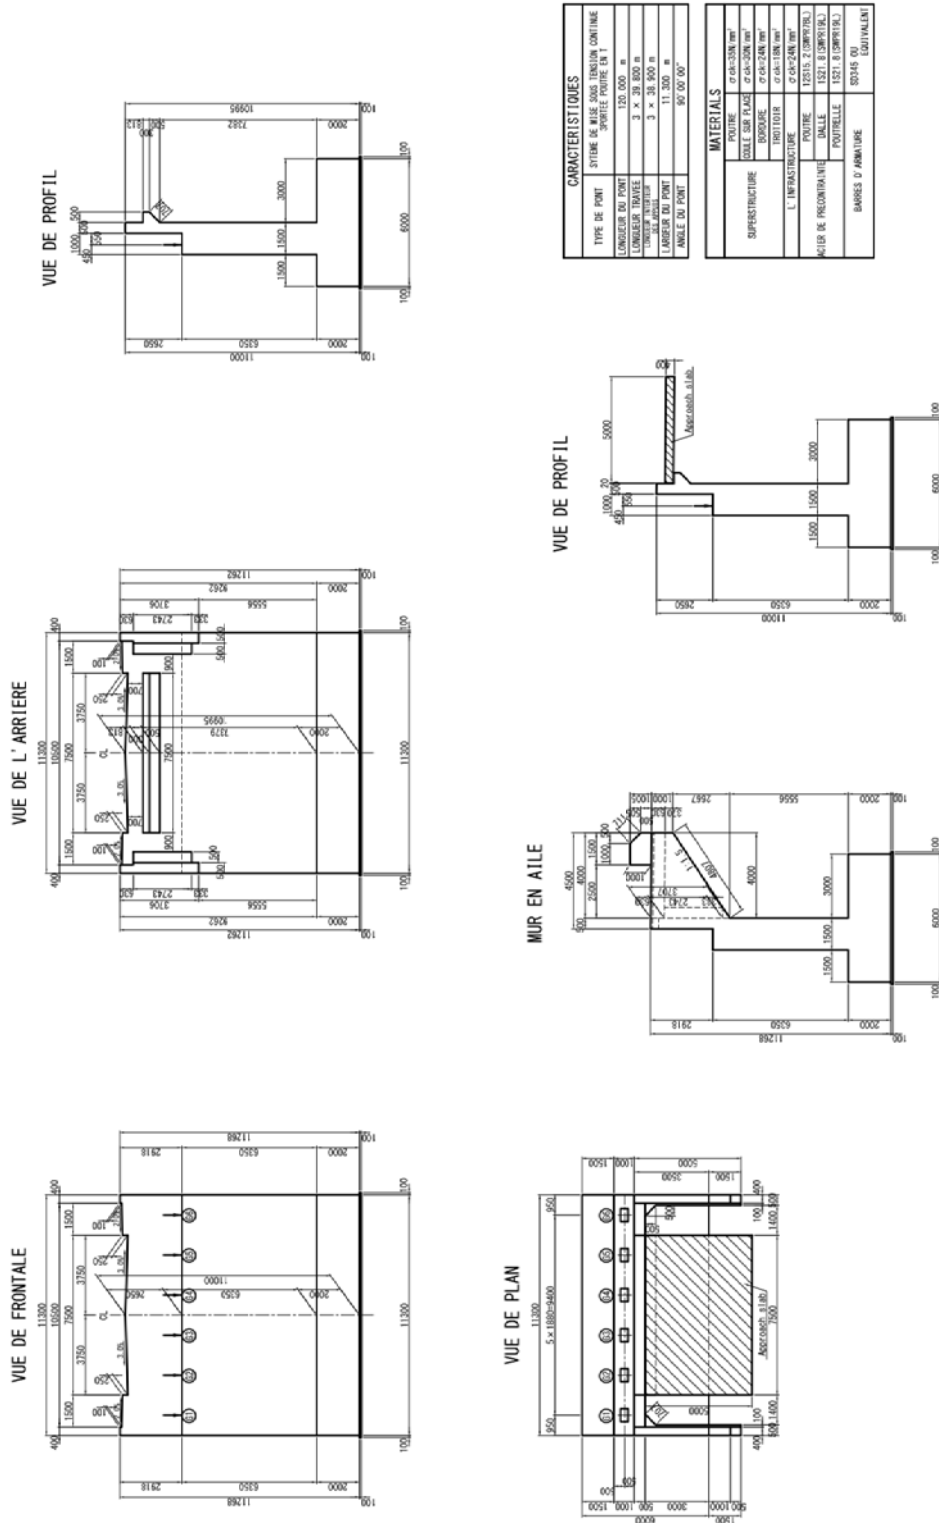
Plan de construction de l'infrastructure du pont sur le fleuve Kara (3)
